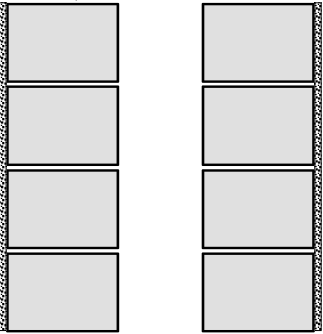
3: Grundrissformen zur Bestimmung der Höchstwerte für Fassaden nach Tabelle 8
